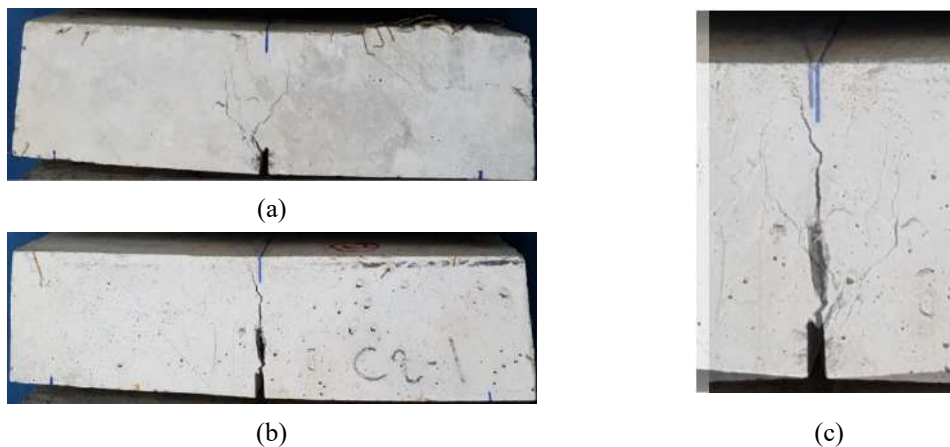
Assimetria do padrão de fissura em corpos de prova prismáticos com dimensões 8 x 8 x 32 cm³: (a) frente do corpo de prova, (b) verso do corpo de prova, e (c) sobreposição das fissuras.
